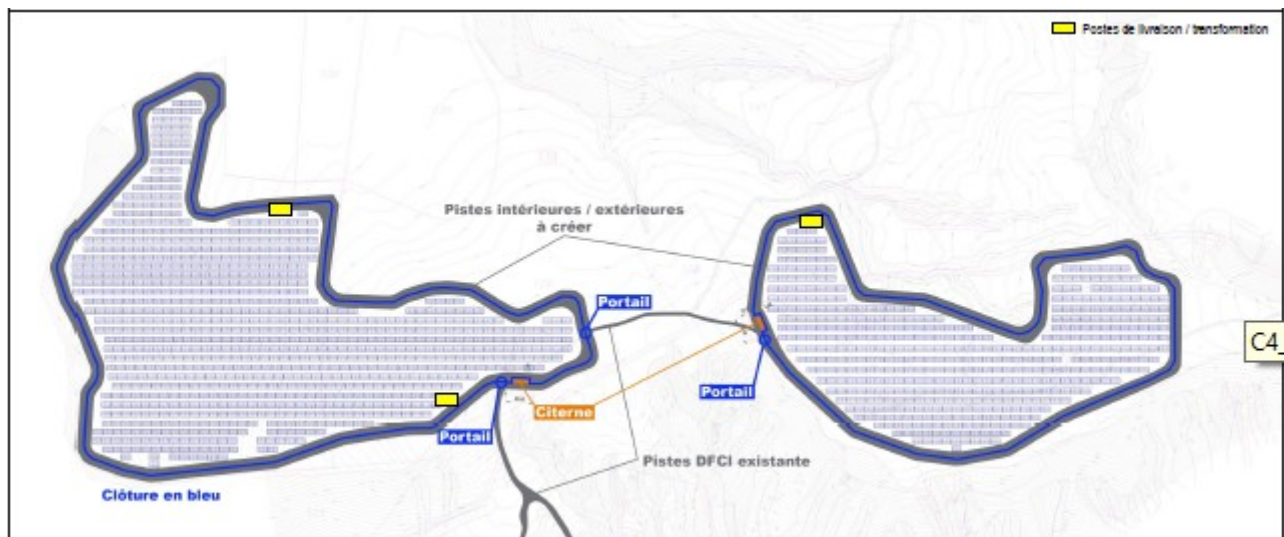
Plan de masse du projet. (source: Etude d'impact p. 129)
